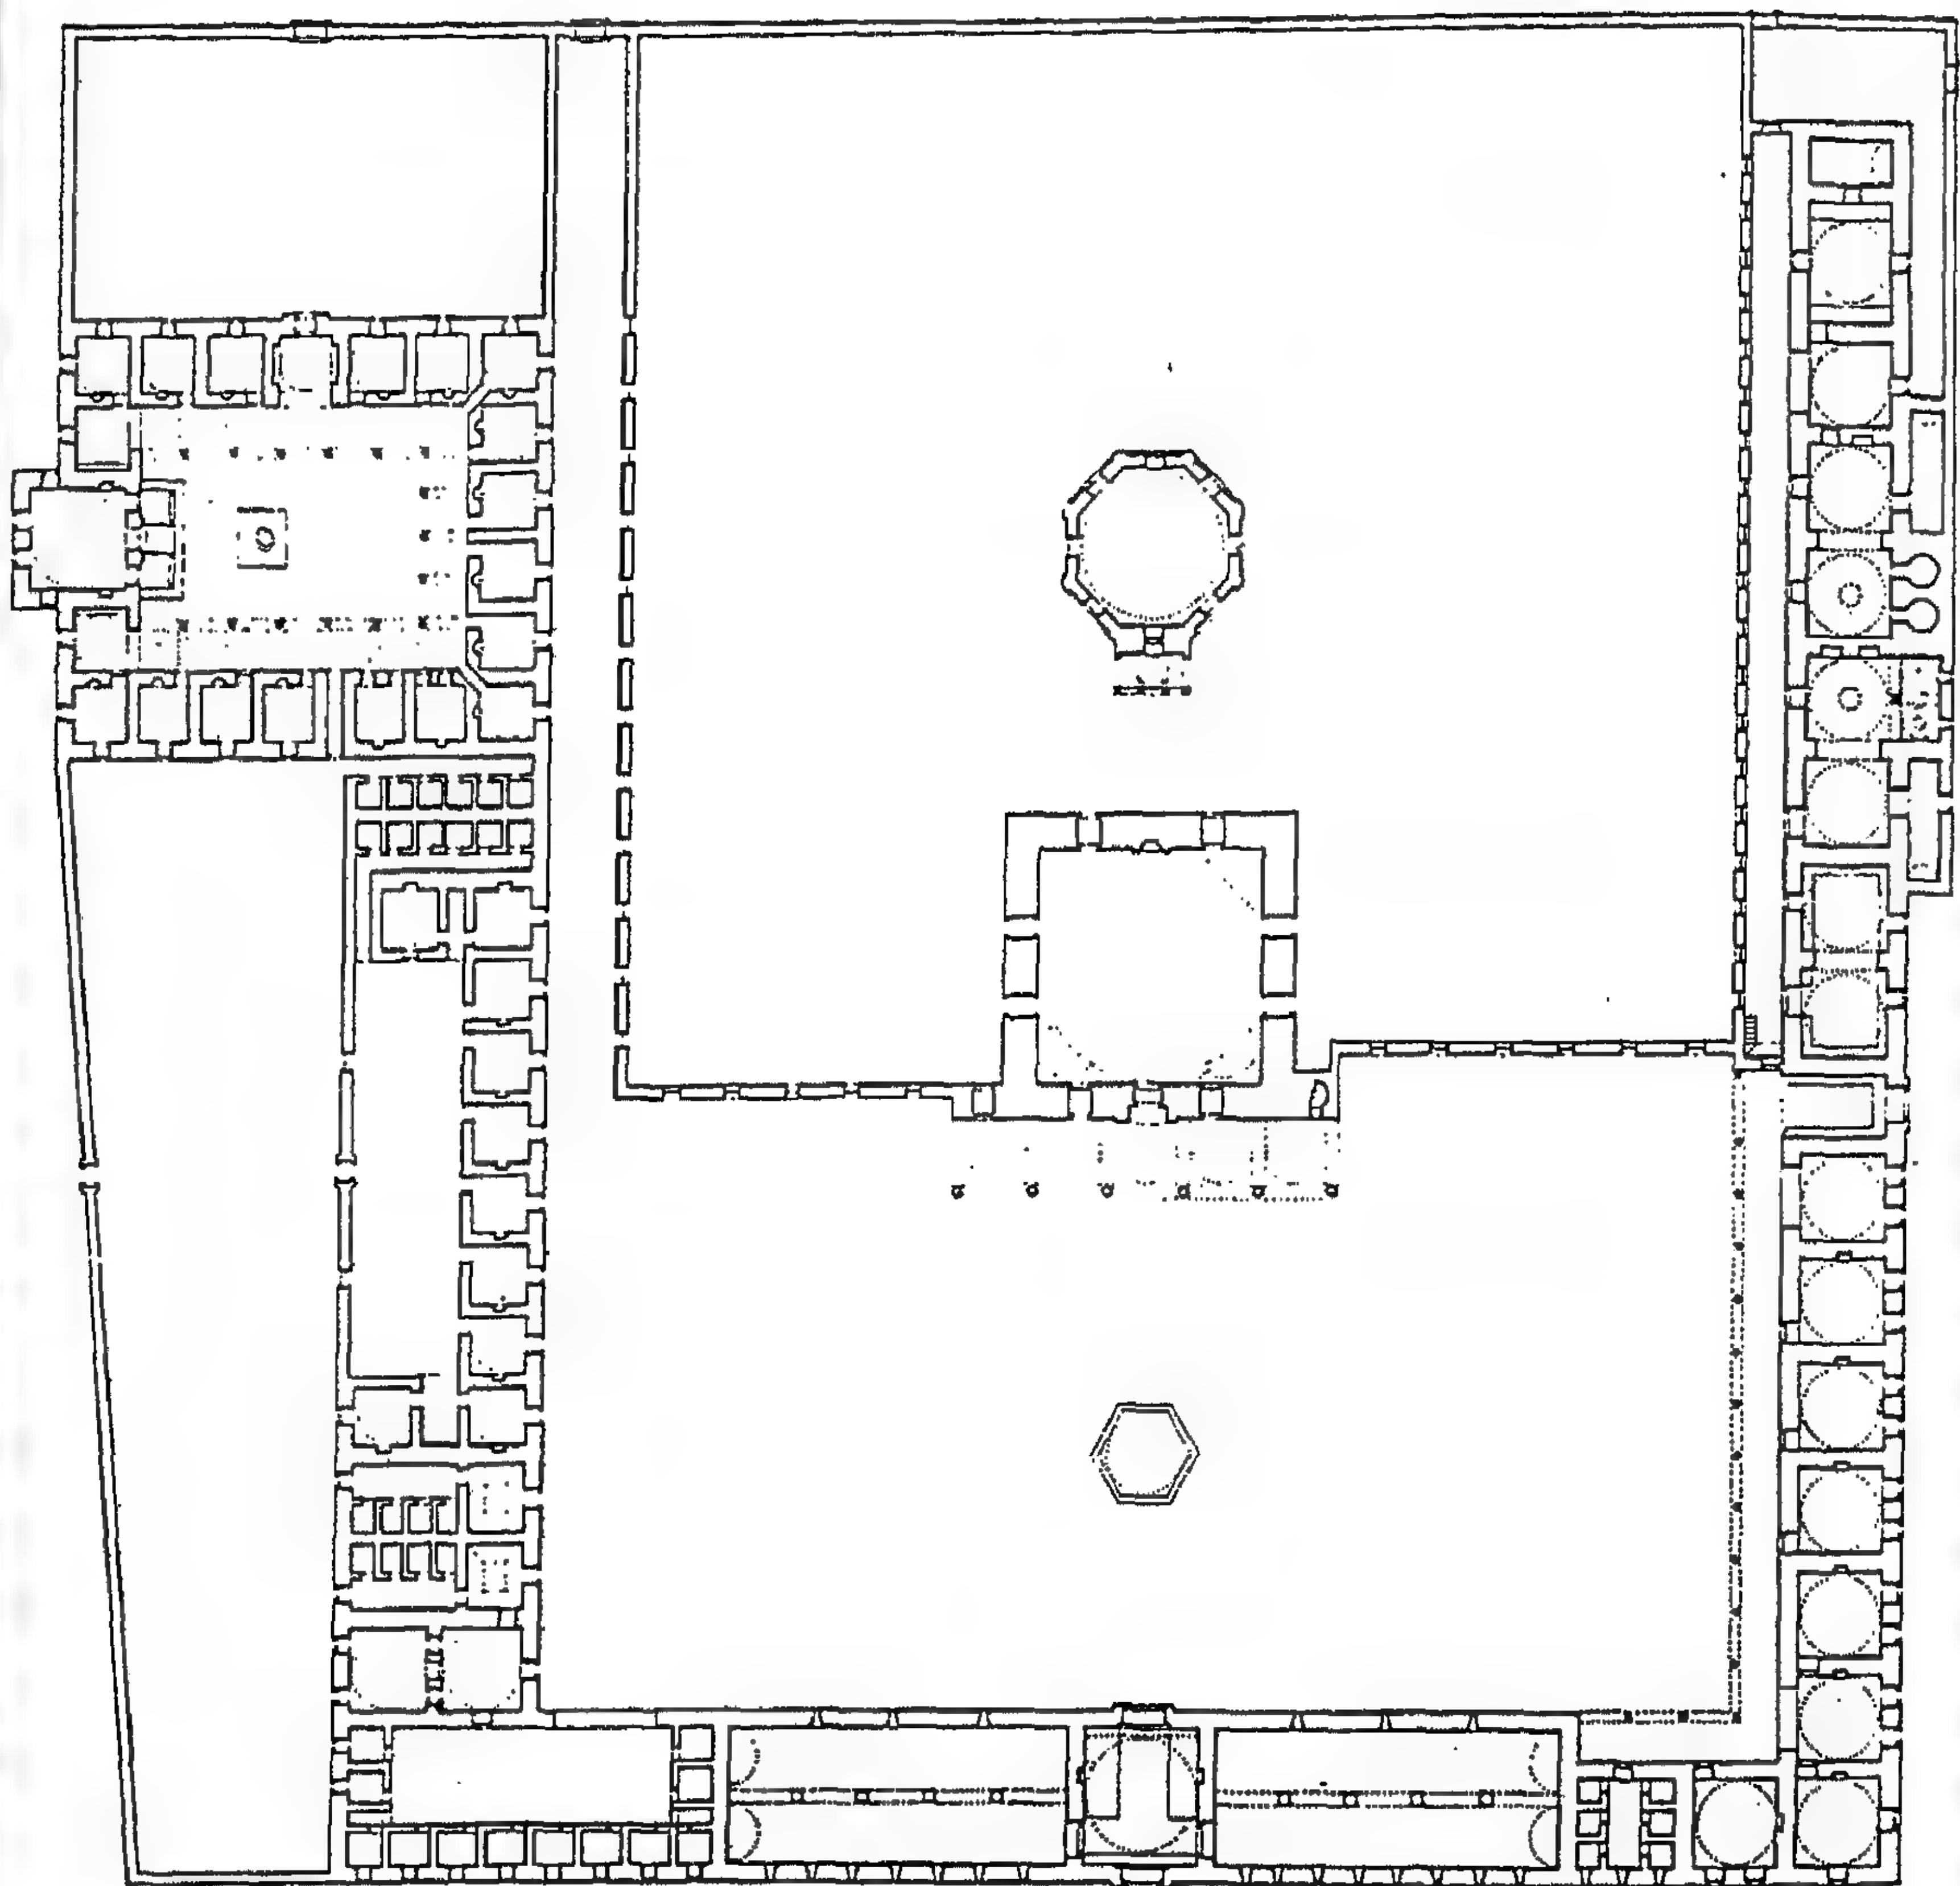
مسقط أفقى لمجمع الباييزيدية بأدرنة.
